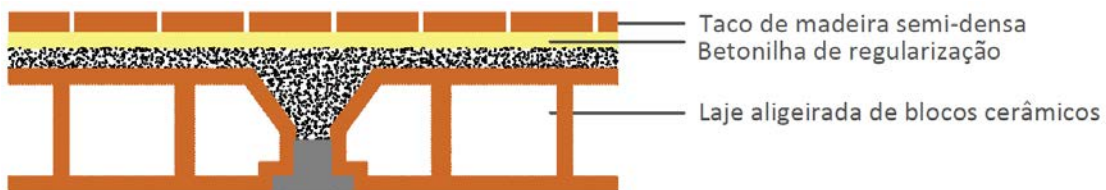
Solução construtiva tipo de pavimento sobre desvão sanitário – Pré intervenção
